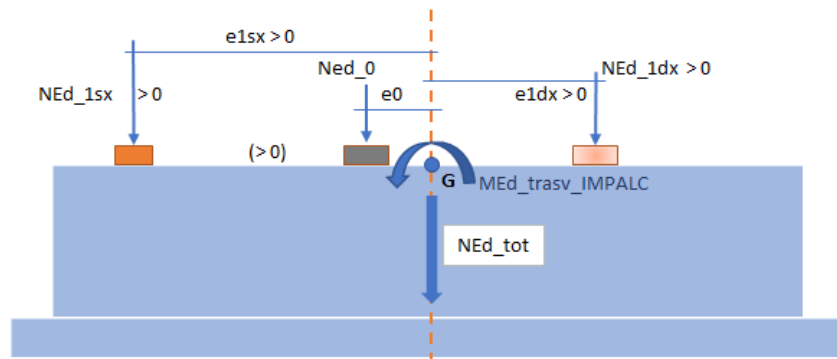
Sezione verticale, trasversale, piano per assi appoggi – schema qualitativo – disposizione assi appoggi da asse spalla/platea. Numero di appoggi rappresentato puramente generale
